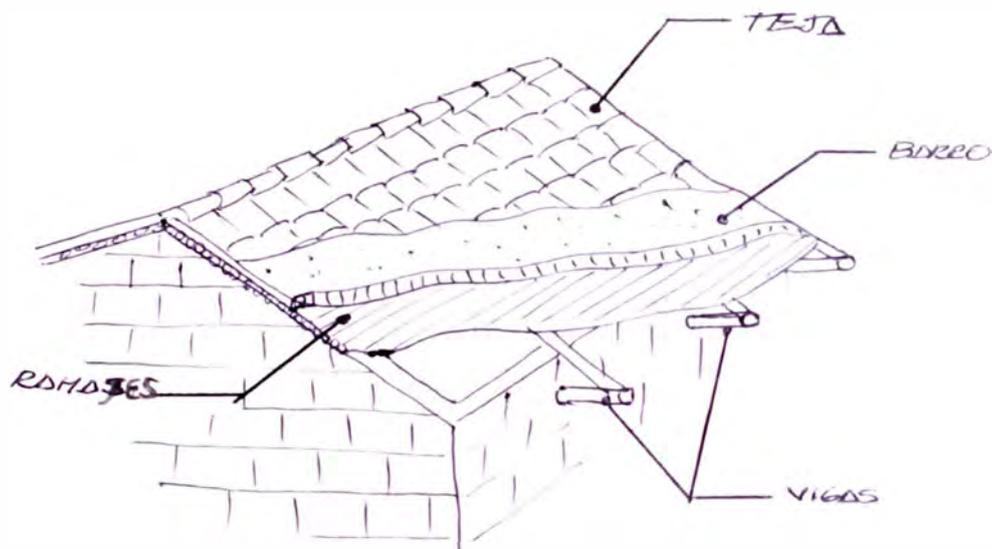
TECHO RECUBIERTO CON TEJAS Y ASENTADAS CON BARRO
